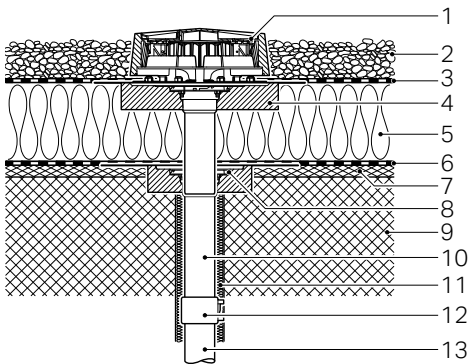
Aufbau Massivdach gedämmt, mit Dachabdichtungsfolie und Dampfsperre
